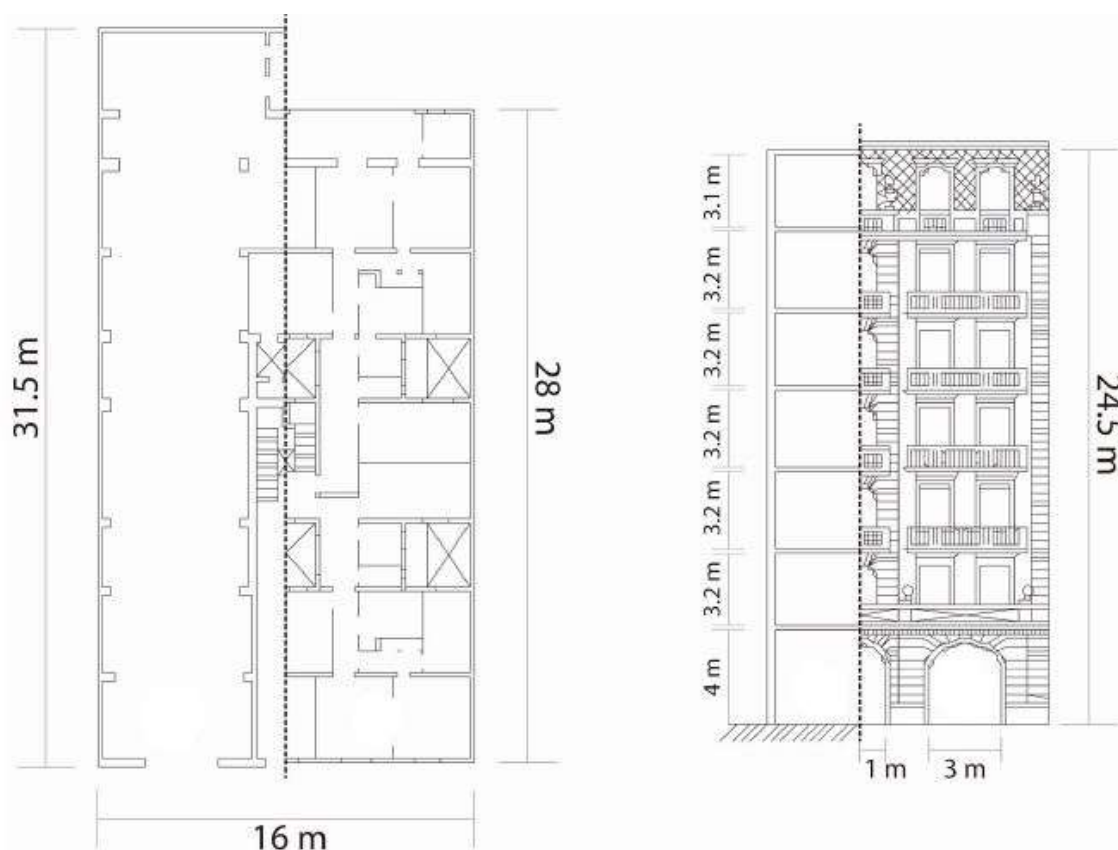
Plano de un edificio de las mismas características que el escogido (modificado de Gonzalez-Drigo et al., 2016)
